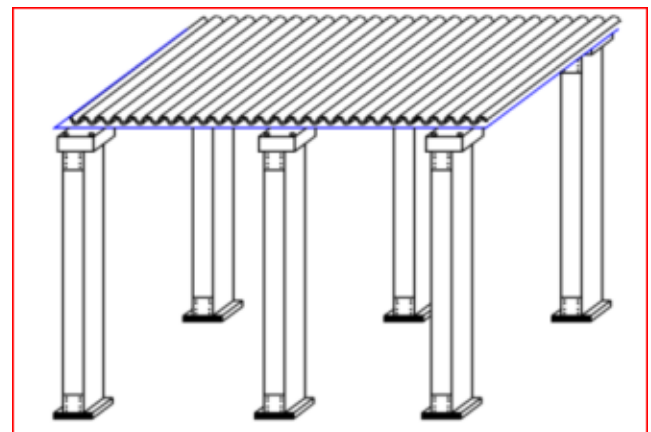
Couvrir l'espace de plancher -Source : L'auteur
